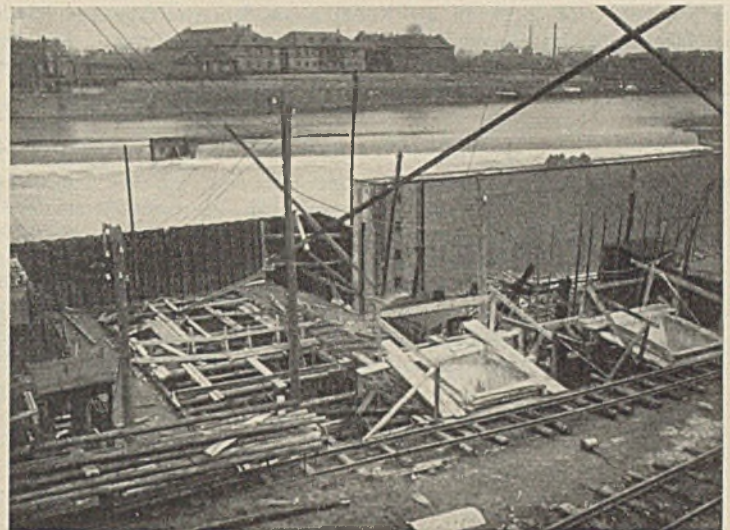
Betonieren des mittleren Sohlendrittels des Unterhauptes.
